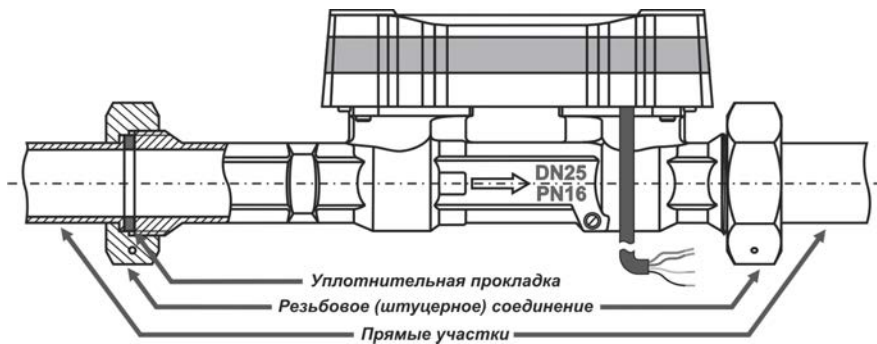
Установка расходомера KAPAT-520-20, -25, -32, -40
